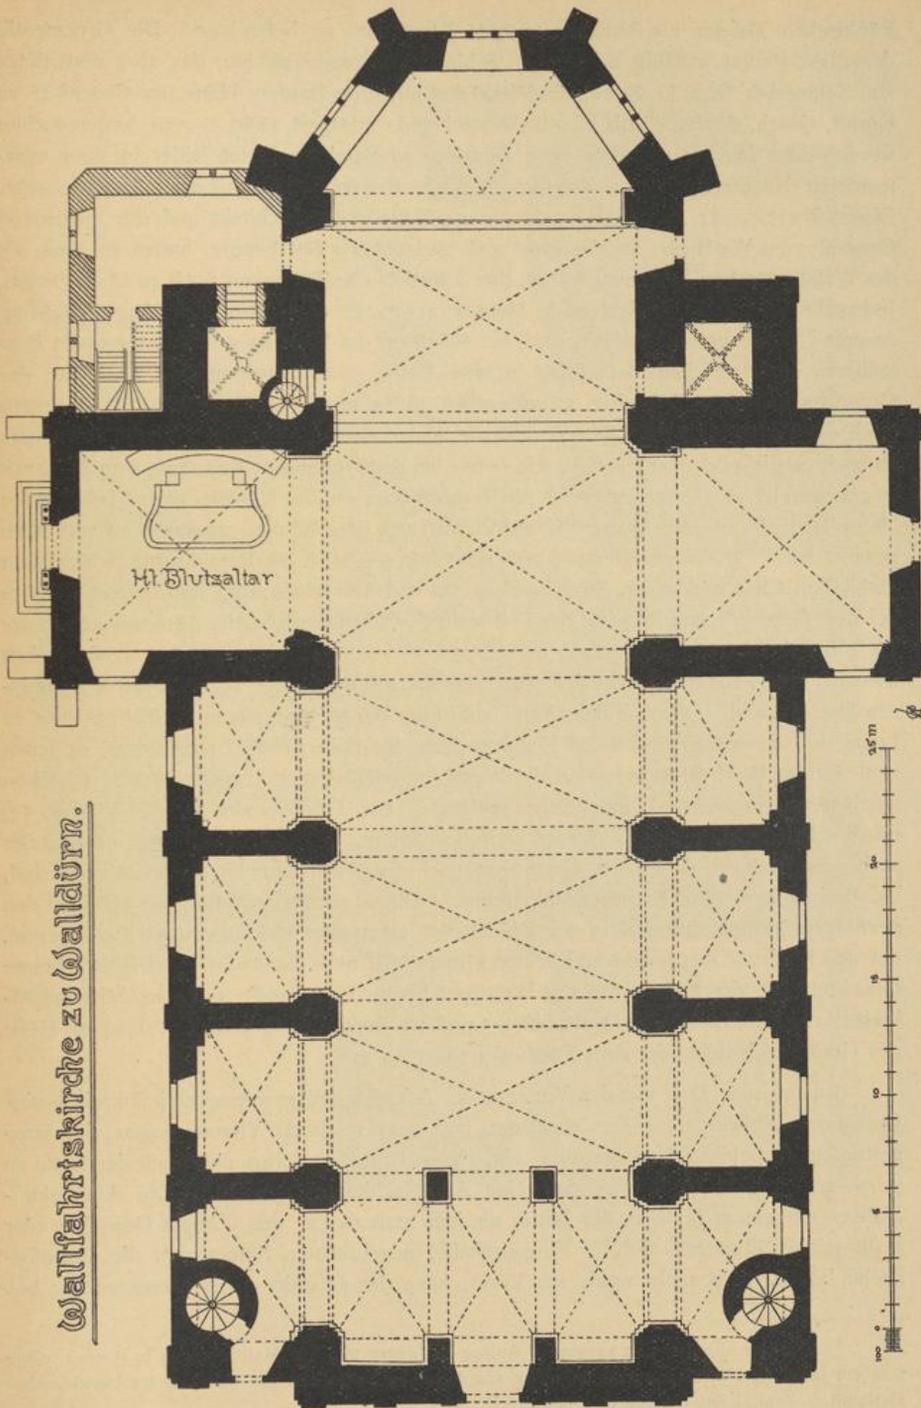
Grundriss der Walltätter Kirche.
